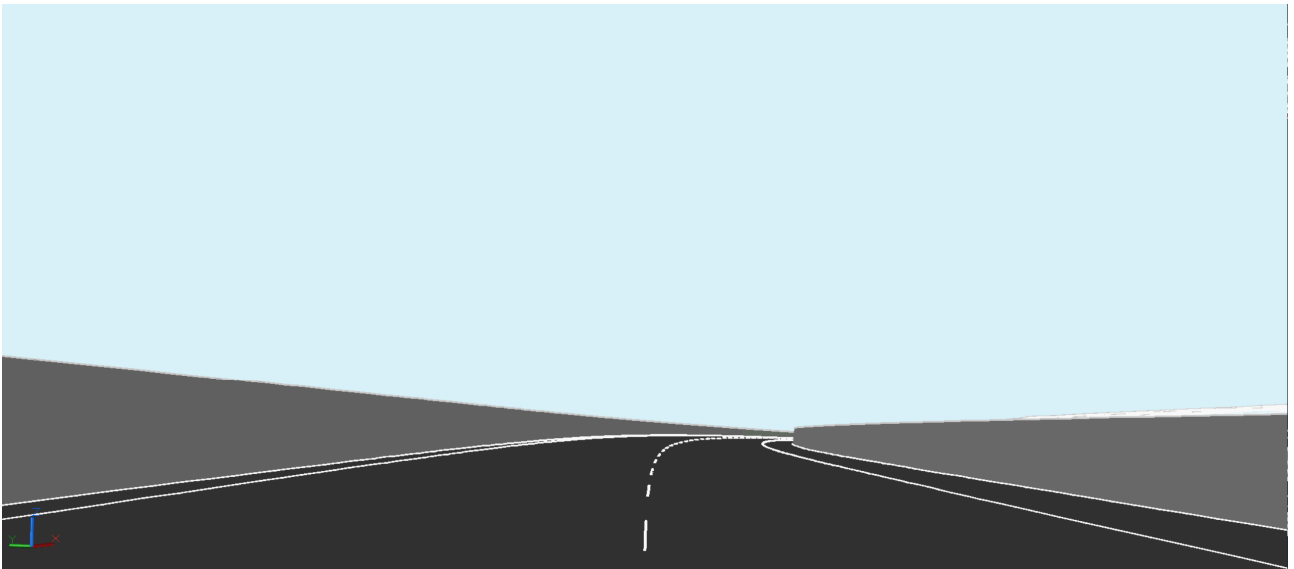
Visione prospettica in ingresso alla curva planimetrica 8 (Carr. GR-FA)
